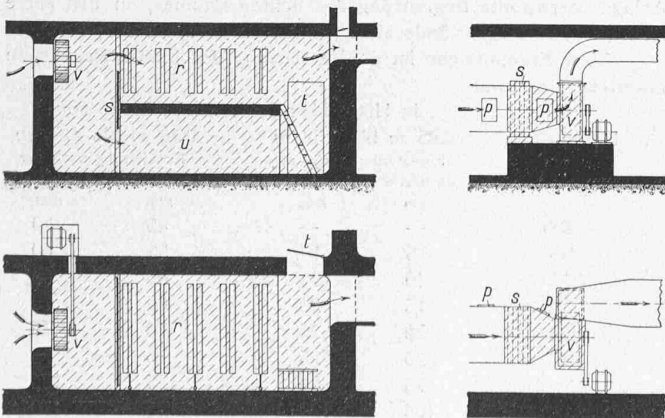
Längsschnitt und Grundriss einer gemauerten Heizkammer früherer Art (links) und eines Sendric-Apparates gleicher Leistung (rechts).
